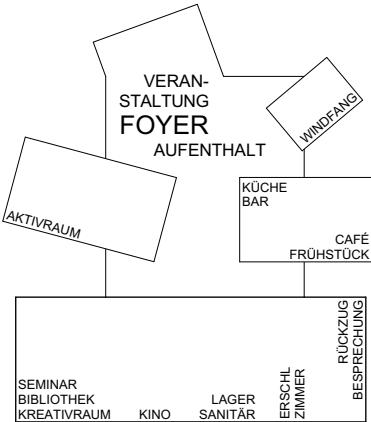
schematischer Grundriss Jugendtreff Tulfes
